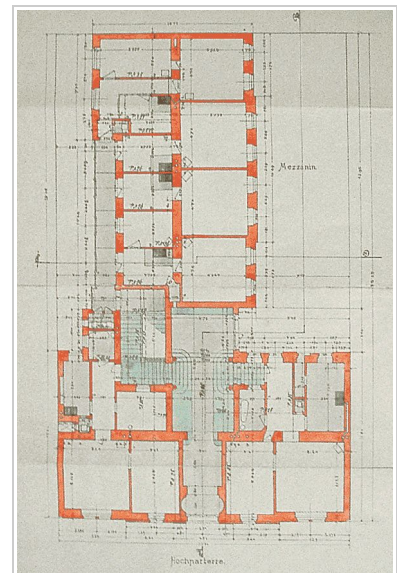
Grundriss des Hochparterres.
